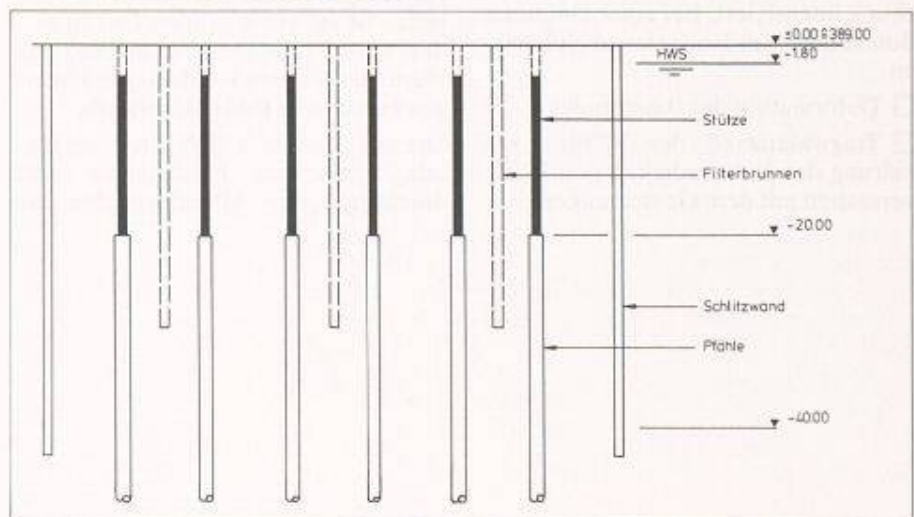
Schema von Baugrubenabschluss und Pfahlfundation
